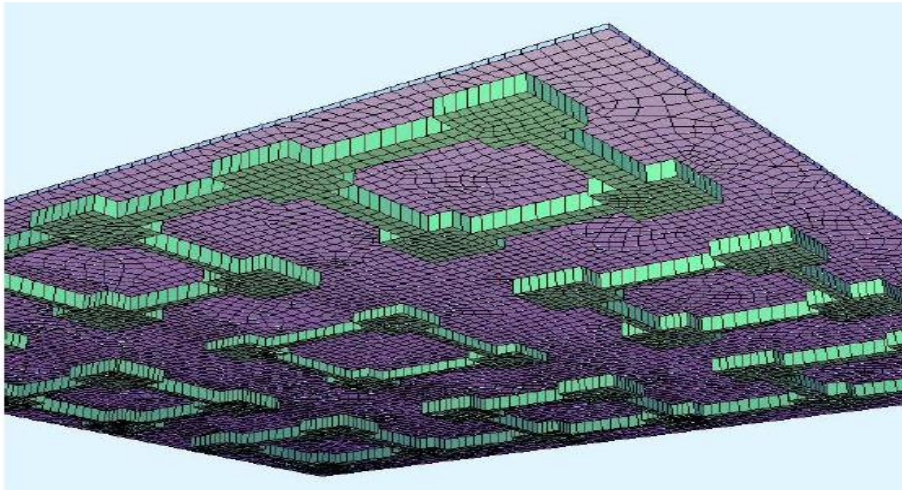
ferrailage du radier et les semelles – exemple pratique
